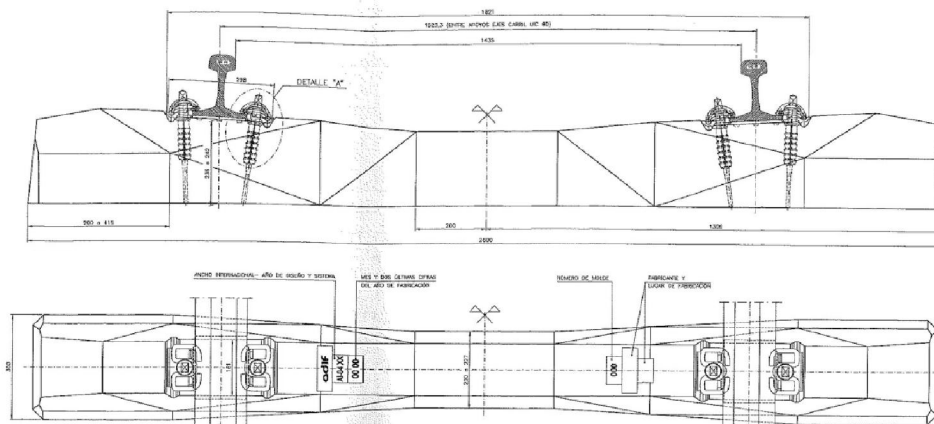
Alçat i planta de la travessa AI-04, extret de [7].
